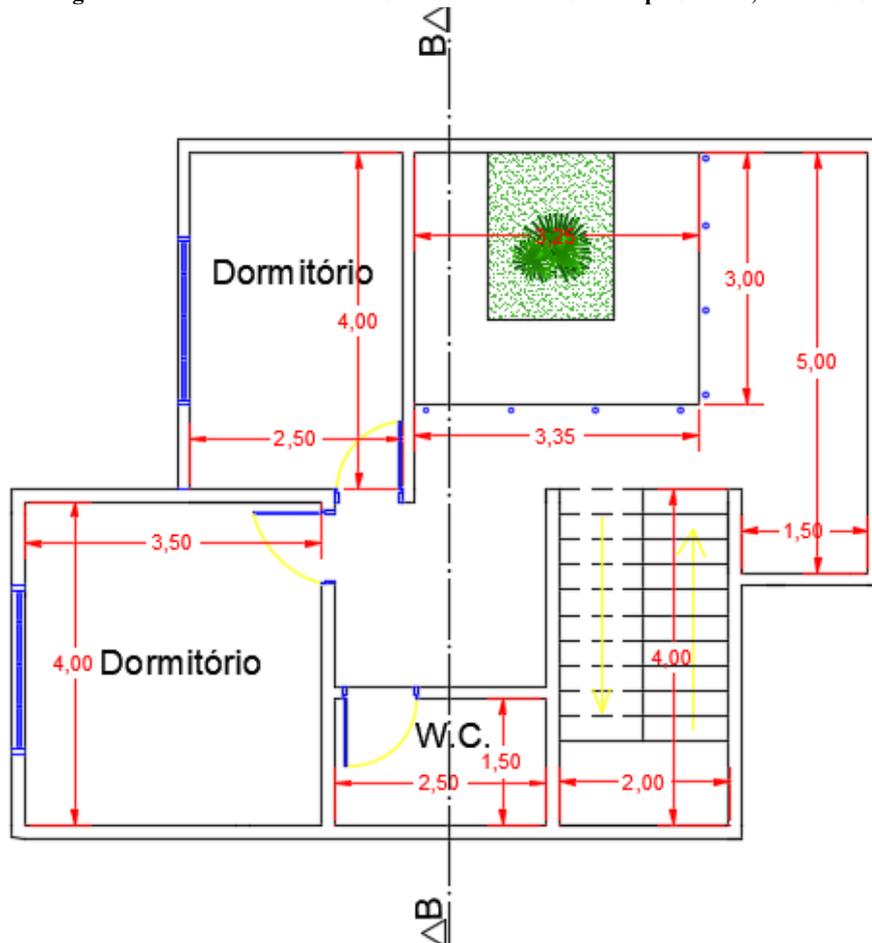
Planta Baixa. Fonte: elaborado pelo aluno, através do software CAD
